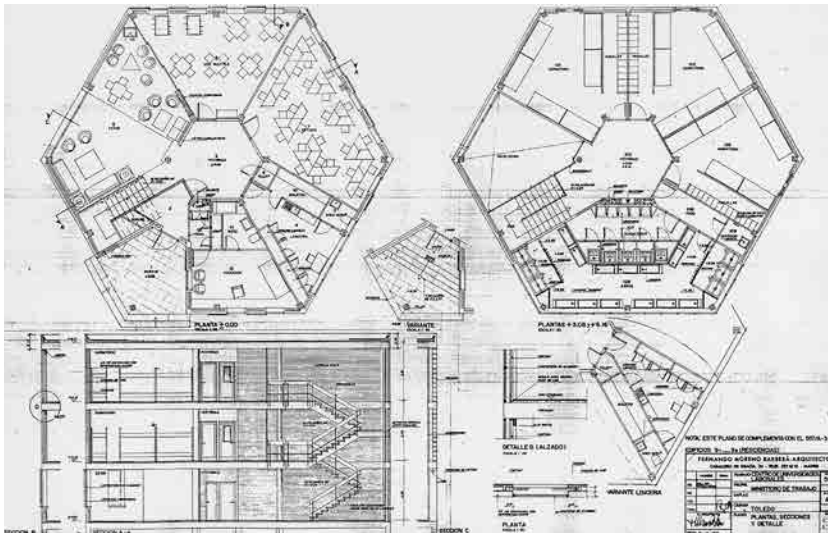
, Fig. 46 y Fig. 47 Residencias. Planta baja (arriba izquierda), planta tipo (arriba derecha) y sección por la escalera (abajo).
